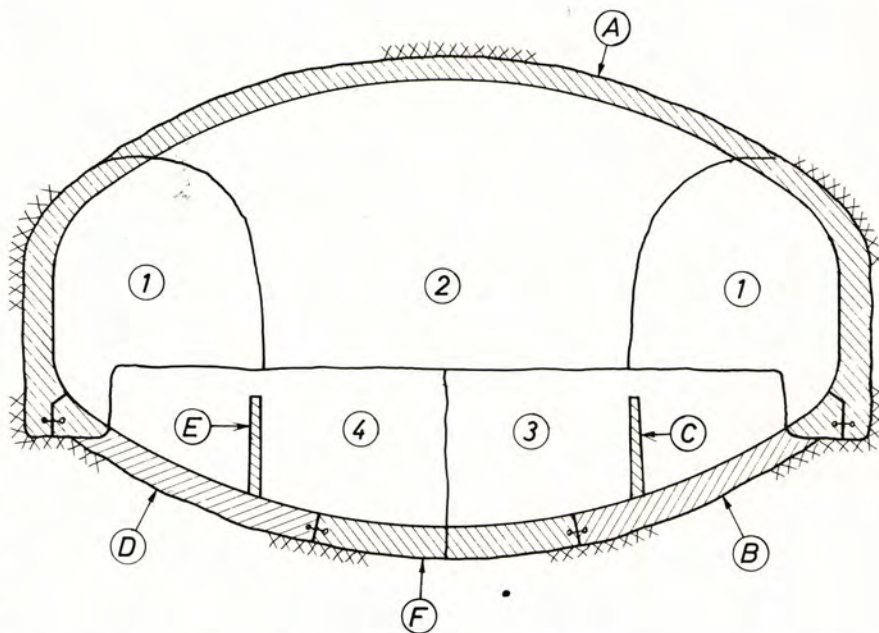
Tverrsnitt av tunnelen ved fryseparti. Åpen byggegrop måtte unngås i det sterkt trafikkerte gatekryss. Ground freezing to support soil in depression extending down close to the tunnel roof. Cut-and-cover working was undesirable due to heavy street traffic at this point. Freezing pipes were drilled from an existing municipal underground tunnel.
